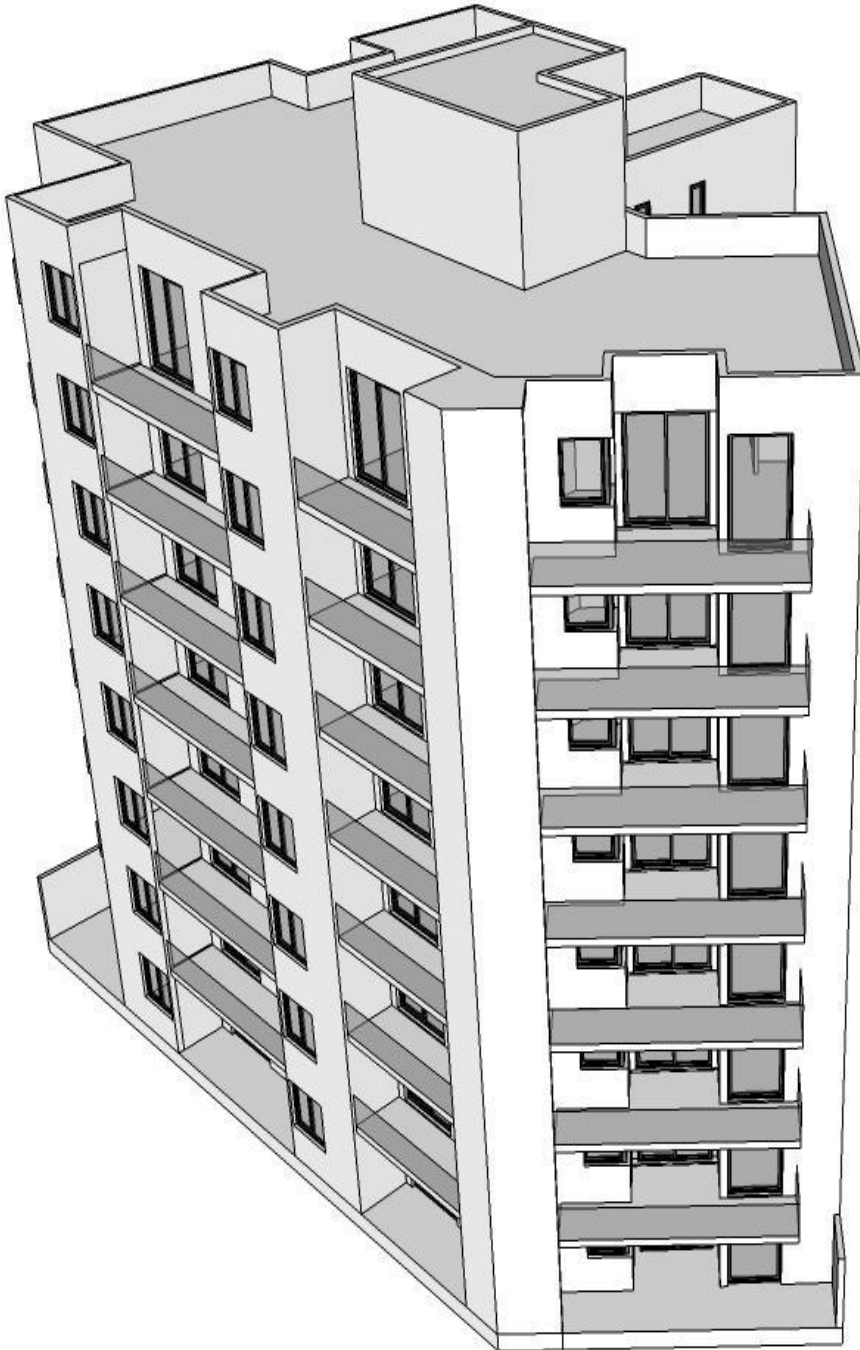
Fachada del edificio. Fuente: (Estudio AVR)
